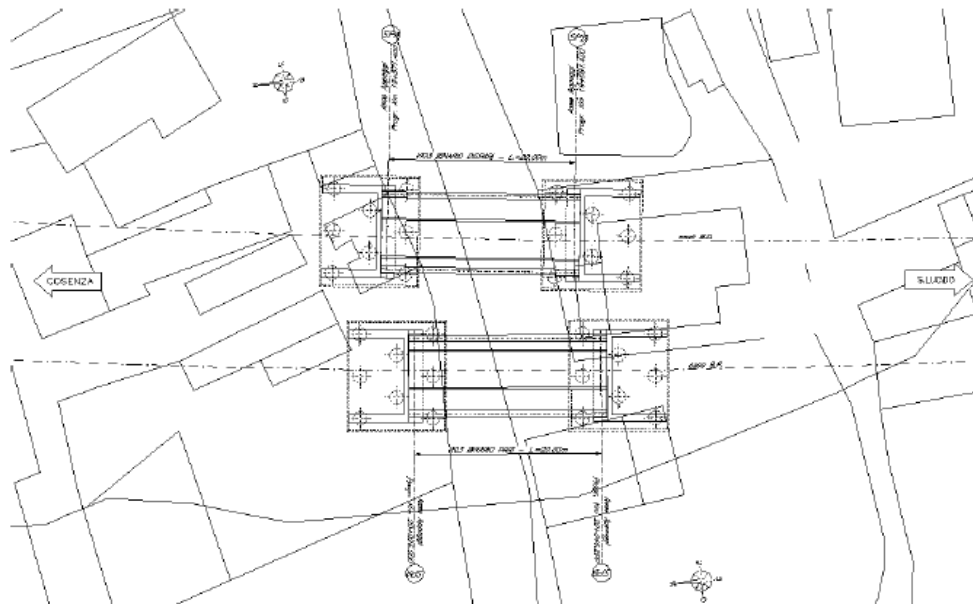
Planimetria dei viadotti ferroviari VI03a e VI03b
